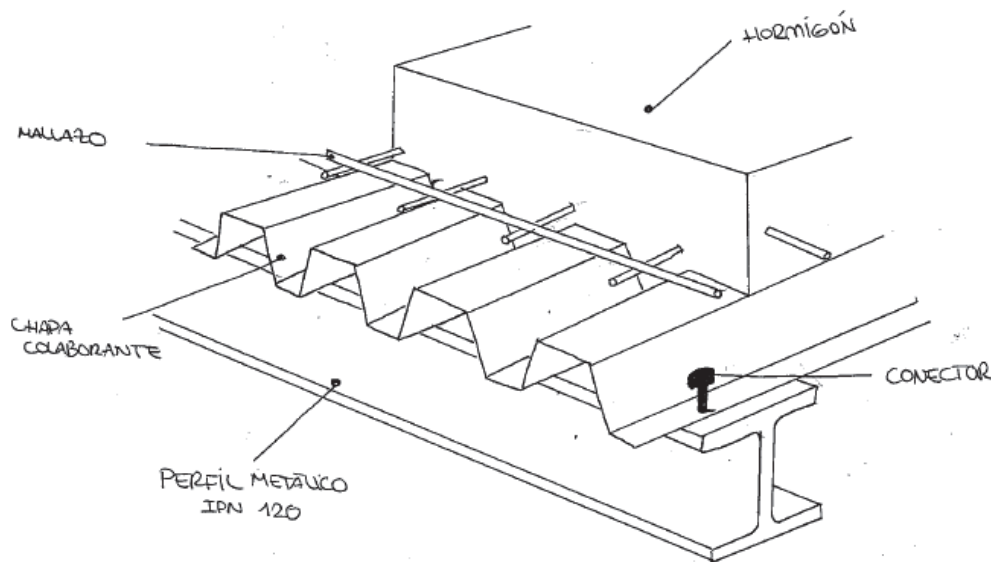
Croquis del forjado colaborante de la planta tercera del campanario. 2014. M^aNieves Pujol.
